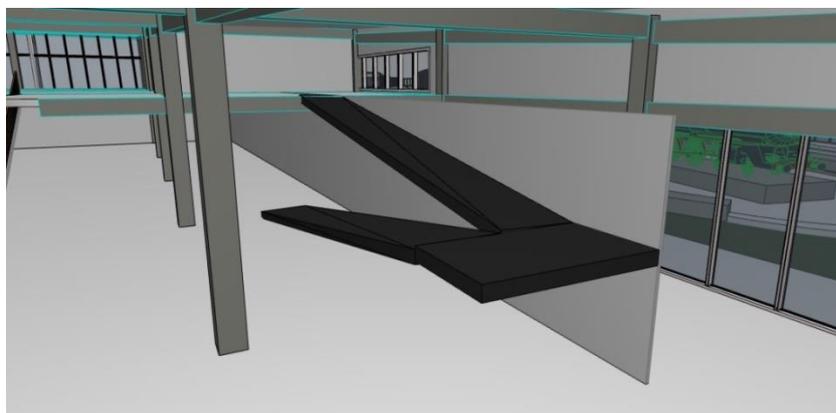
Skema Sirkulasi Diffabel di dalam bangunan
